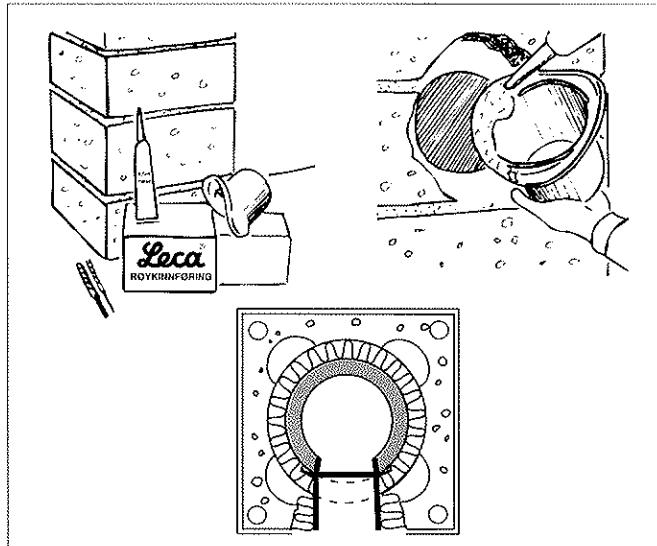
Montering av røykinnføring. Tettig er meget viktig.
